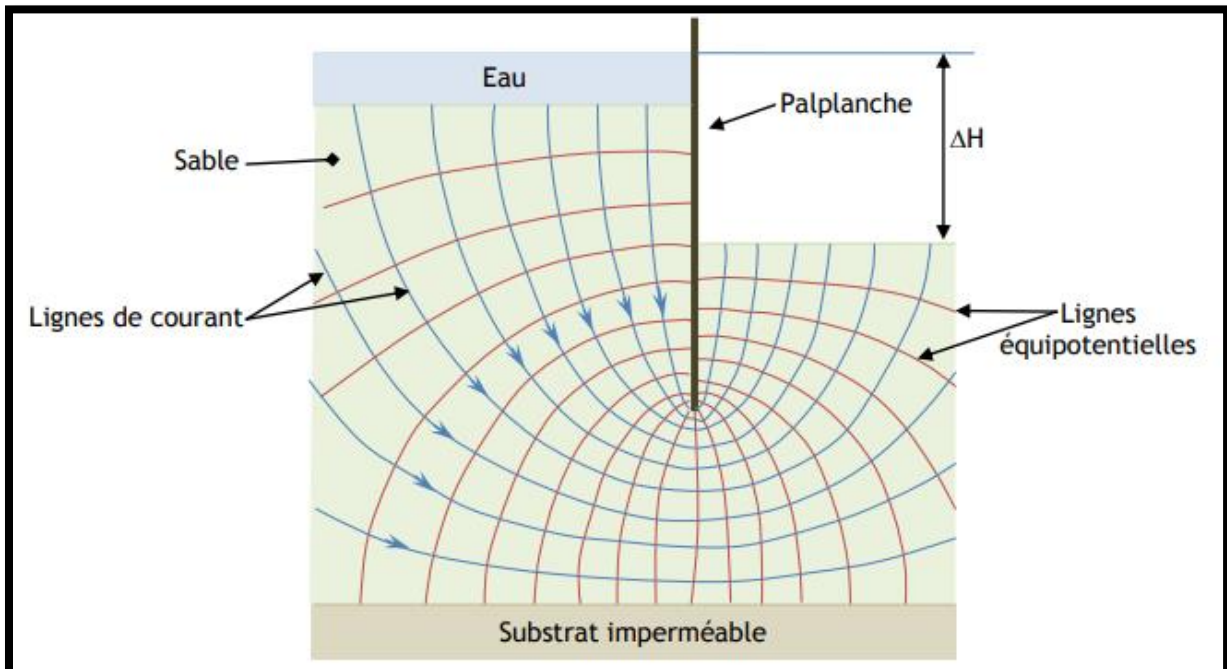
Exemple d'un réseau hydraulique autour d'une palplanche (26)
